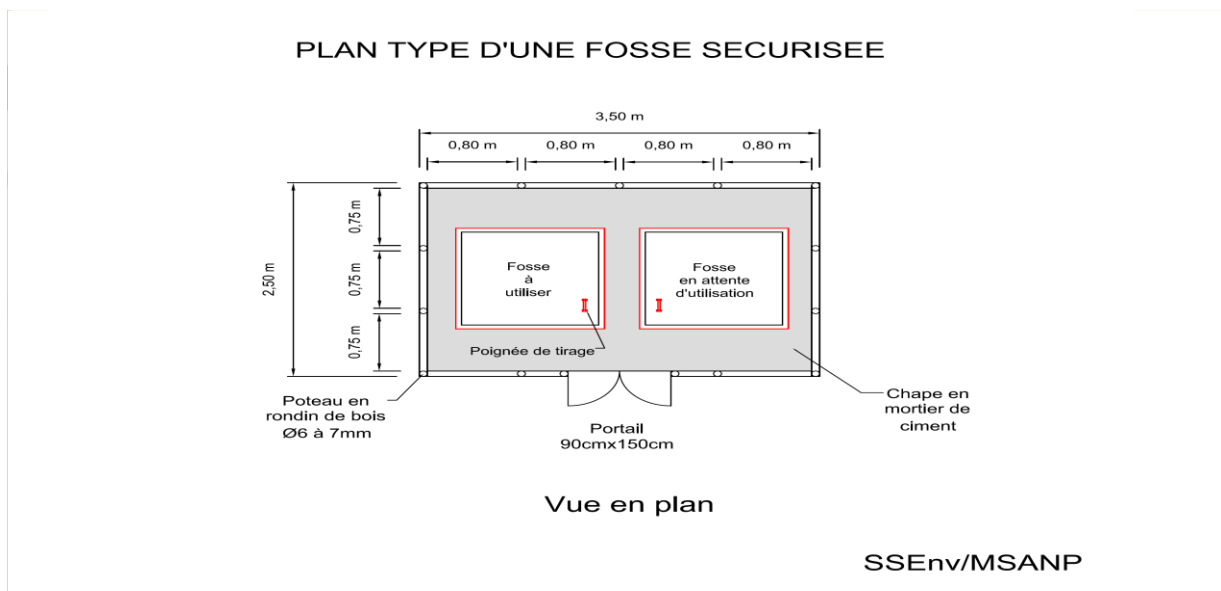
Plan type d'une fosse sécurisée - Vue en plan
